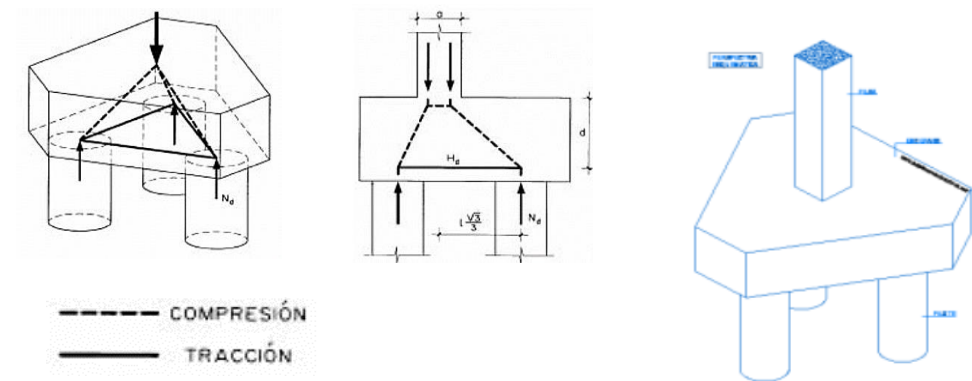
Detalle encepado de 3 pilotes para la cimentación de un pilar de hormigón armado
